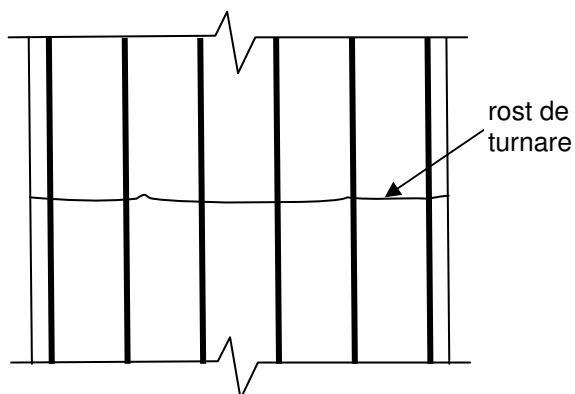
Rost de turnare la un perete structural de beton armat
